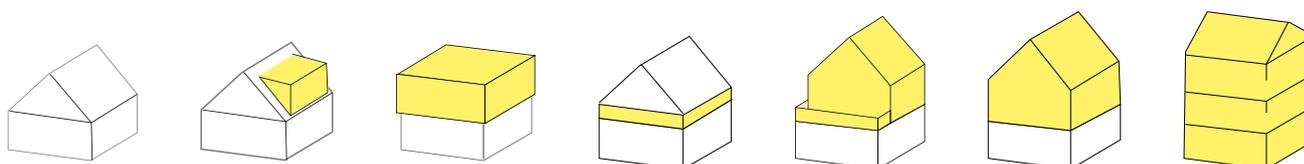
Darstellung von unterschiedlichen Möglichkeiten zur Nachverdichtung: Ursprungsgebäude, Gaube, Flachdachaufbau, Erhöhung des Kniestocks, teilweise Aufstockung und Terrasse, Aufstockung mit Satteldach, Abbruch und Neubau. Eigene Darstellung
